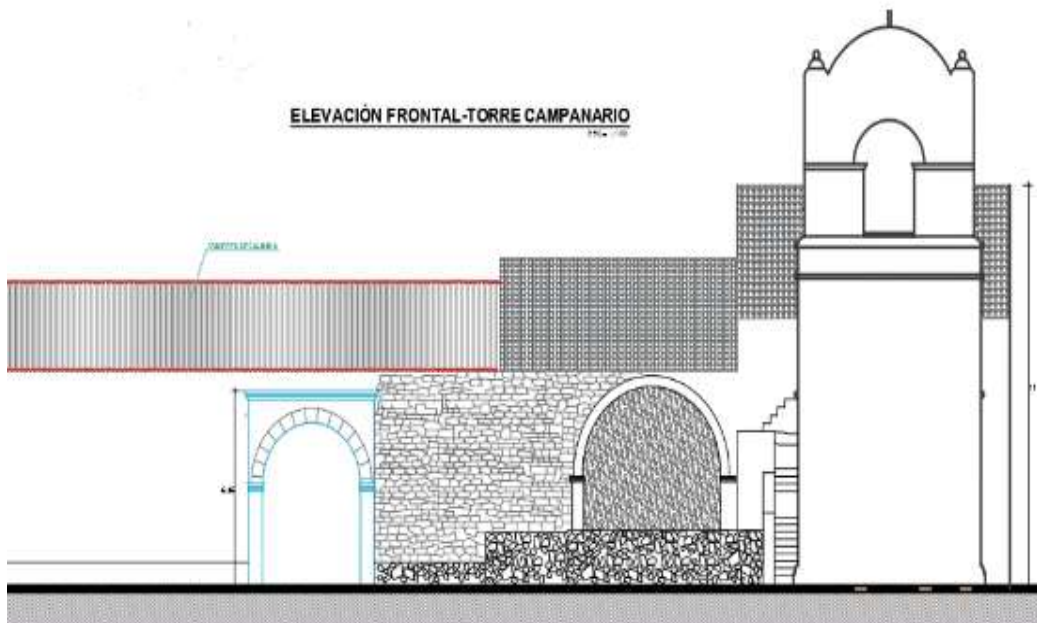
Plano de elevación (Santiago Apóstol de Madrigal)
